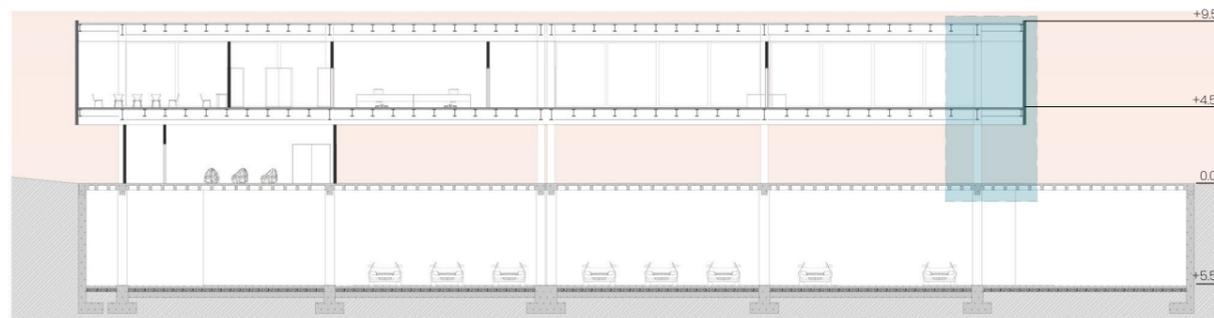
Sección constructiva bloque sur Fuente: Propia, 2022
